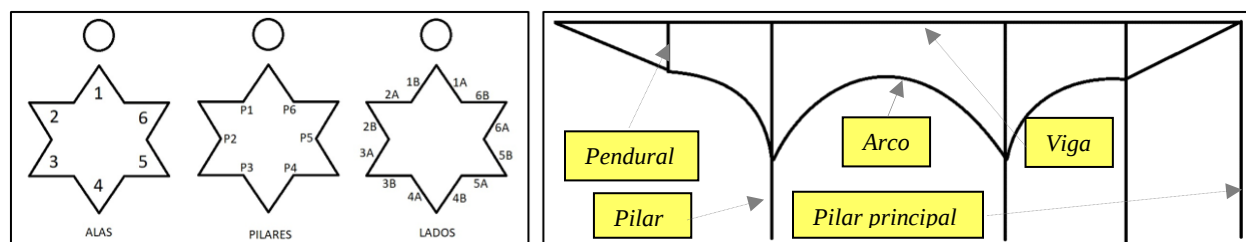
Croquis esquemáticos em planta (à esquerda) e em elevação (à direita) com as nomenclaturas das alas e dos pilares principais.
